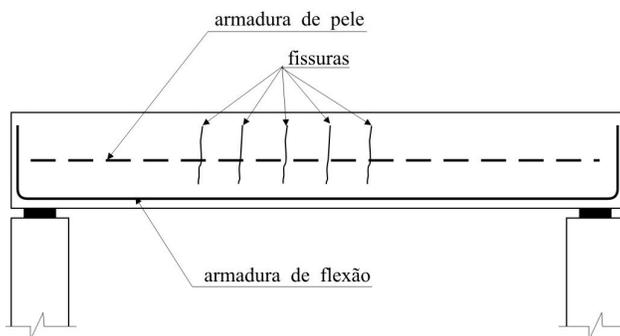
Fissuras verticais a meia altura das vigas
